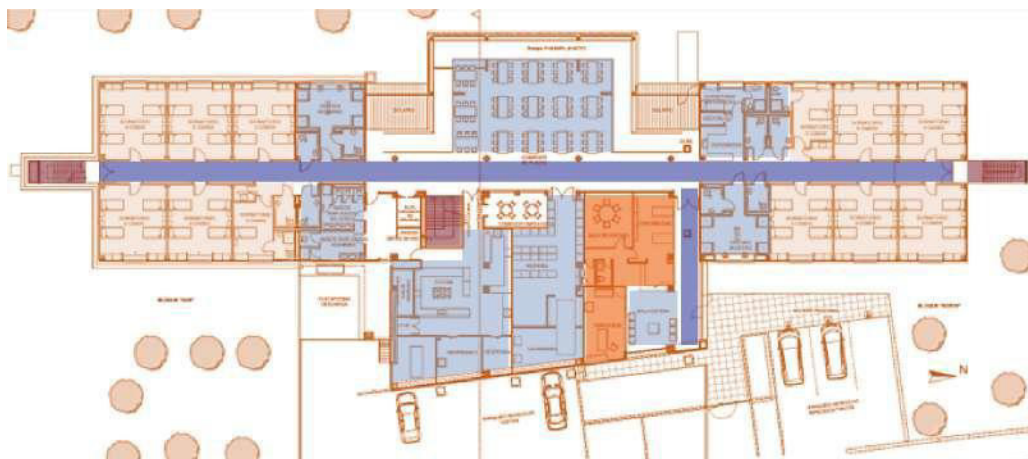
Planta baja-Organigrama. Fuente: Elaboración propia
